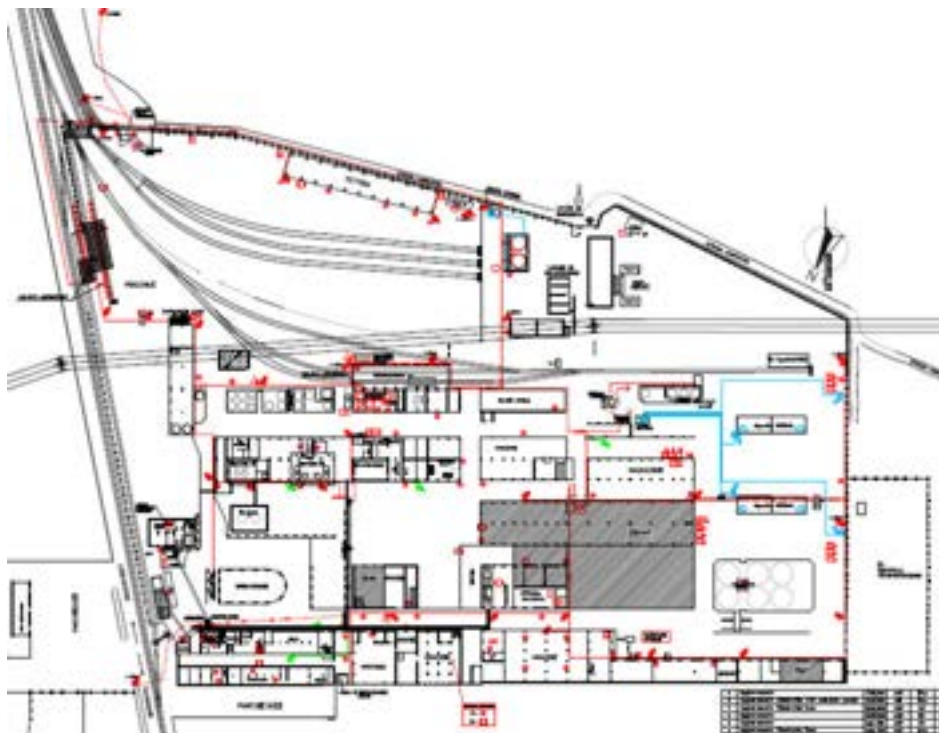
Planimetria antincendio stabilimento di Tavazzano.
